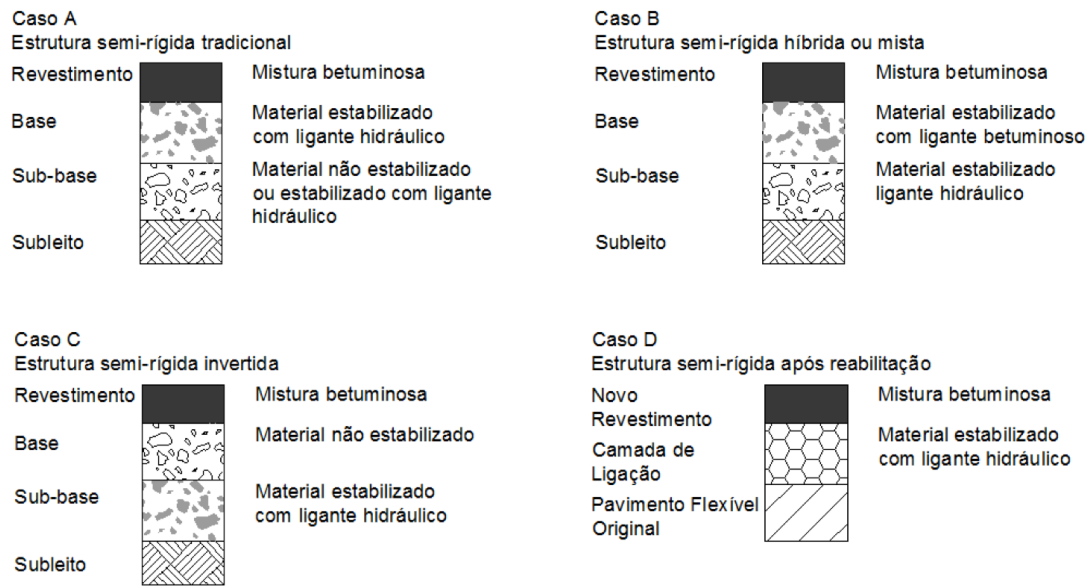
tipos de pavimento semi-rígido (BALBO, 2007, p.52)
